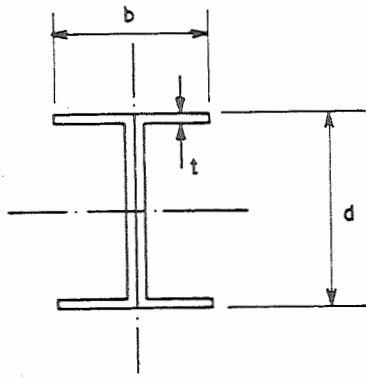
DIMENSÕES DE SEÇÃO I
